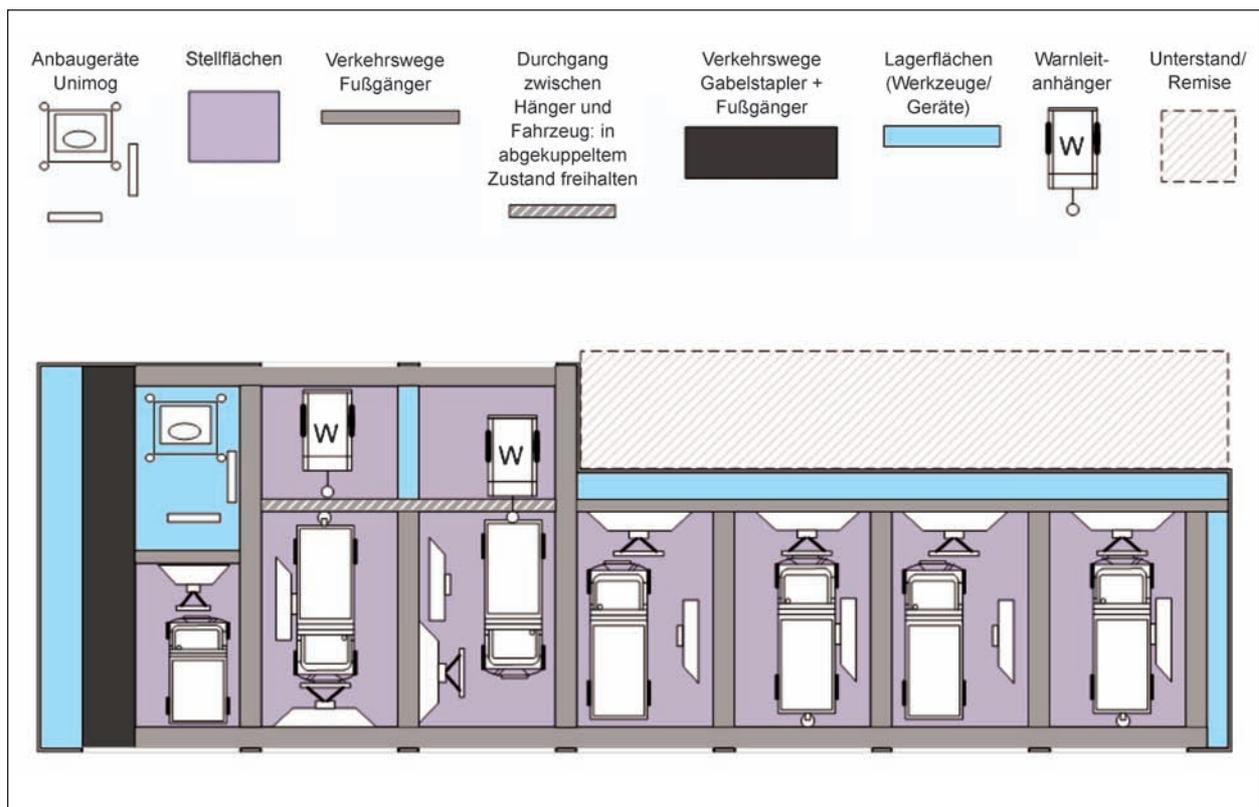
Halle für Großfahrzeuge und Geräte einer AM – Funktionszeichnung 3
